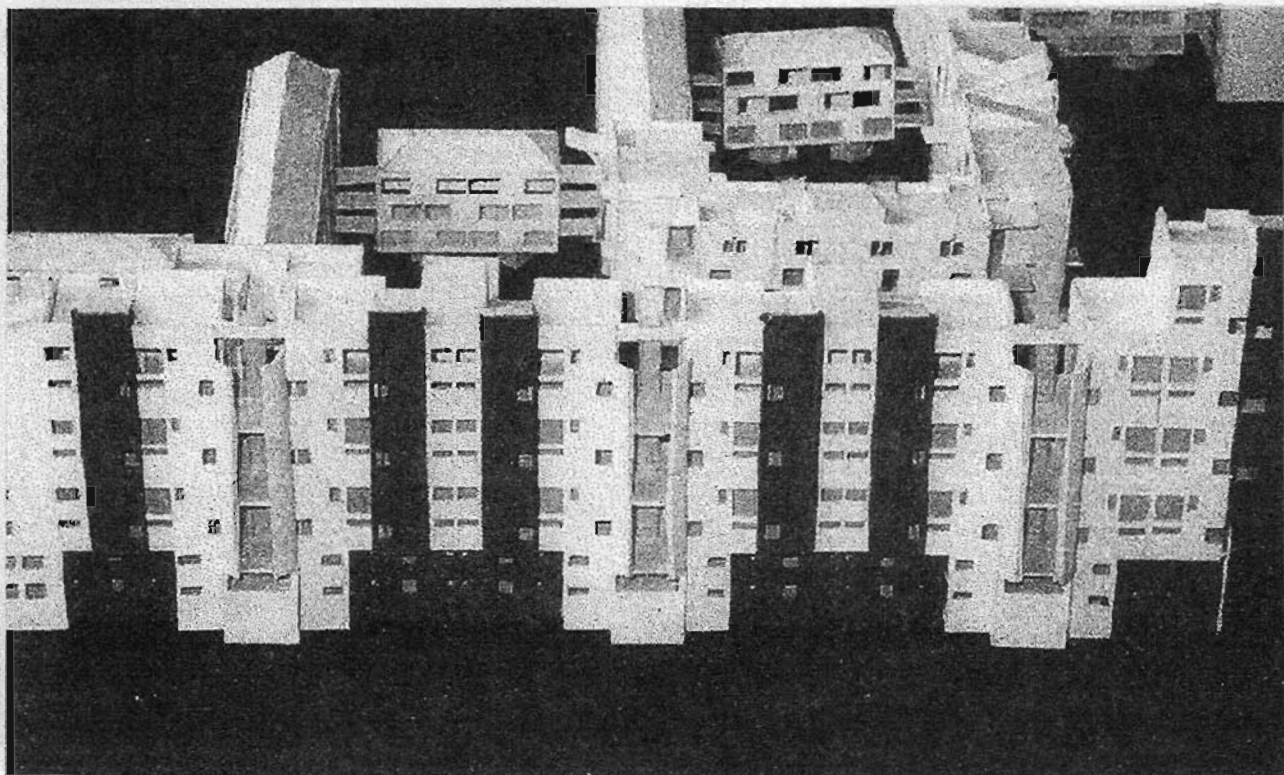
Fachada sur del edificio borde panamericana con mayor grados de cerramiento, mostrando módulo de edificio según agrupación en torno a ejes verticales correspondientes a las cajas de escalera y disposición de ascensores.
